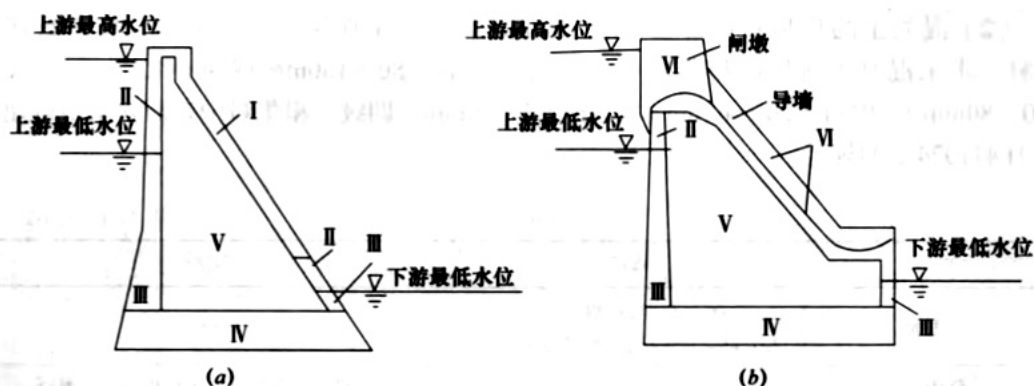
F411024-1 混凝土重力坝各部位混凝土分区示意图
